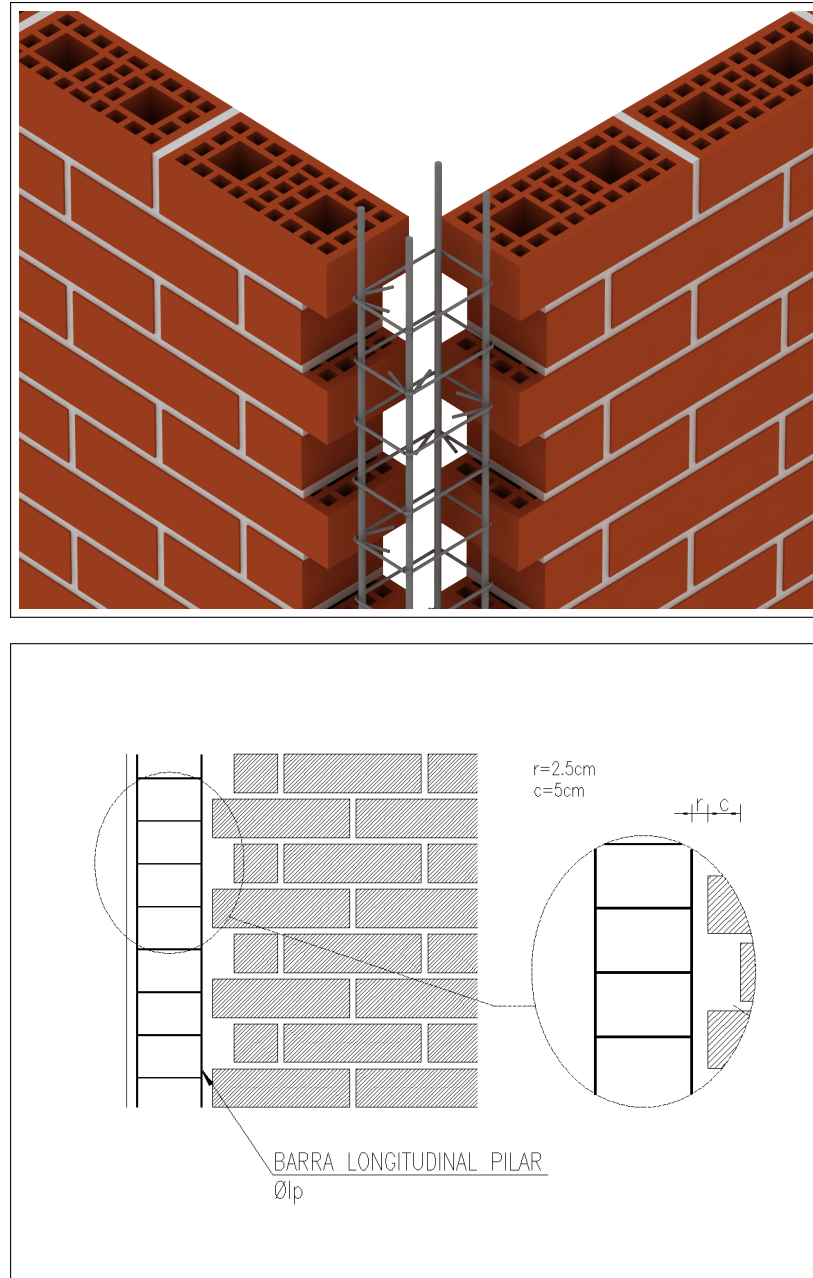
Detalle de la unión endentada entre el paño de albañilería y un pilar de confinamiento en el encuentro de muros.
